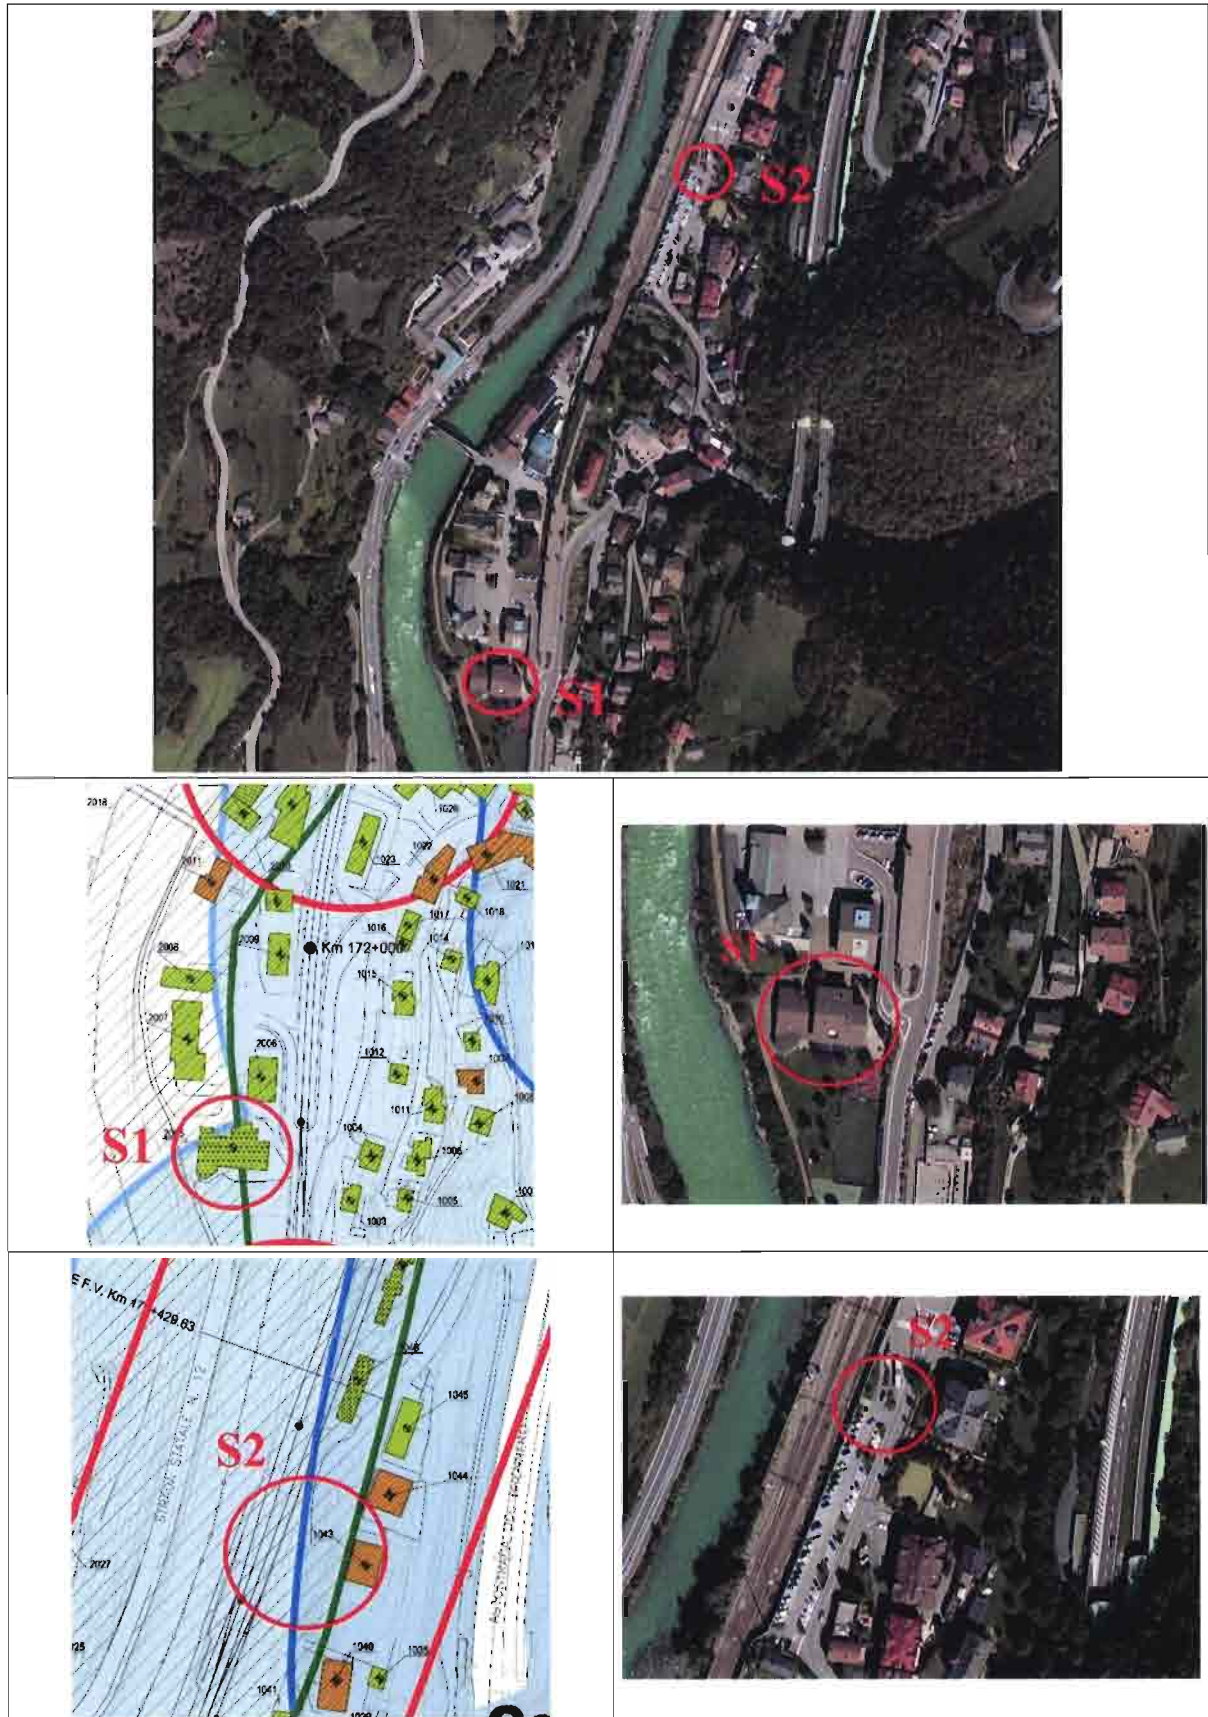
Localizzazioni e planimetrie delle sezioni di misura
